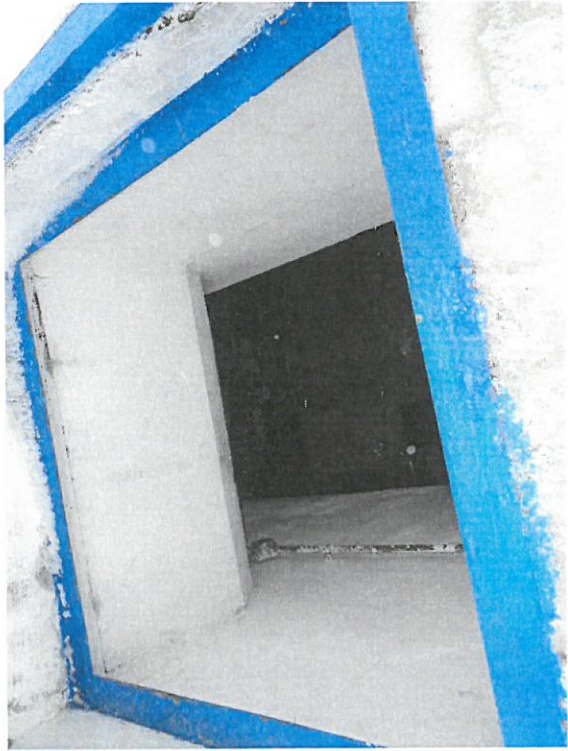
Puț de captare zona „captarea noua”-vedere interioara.
